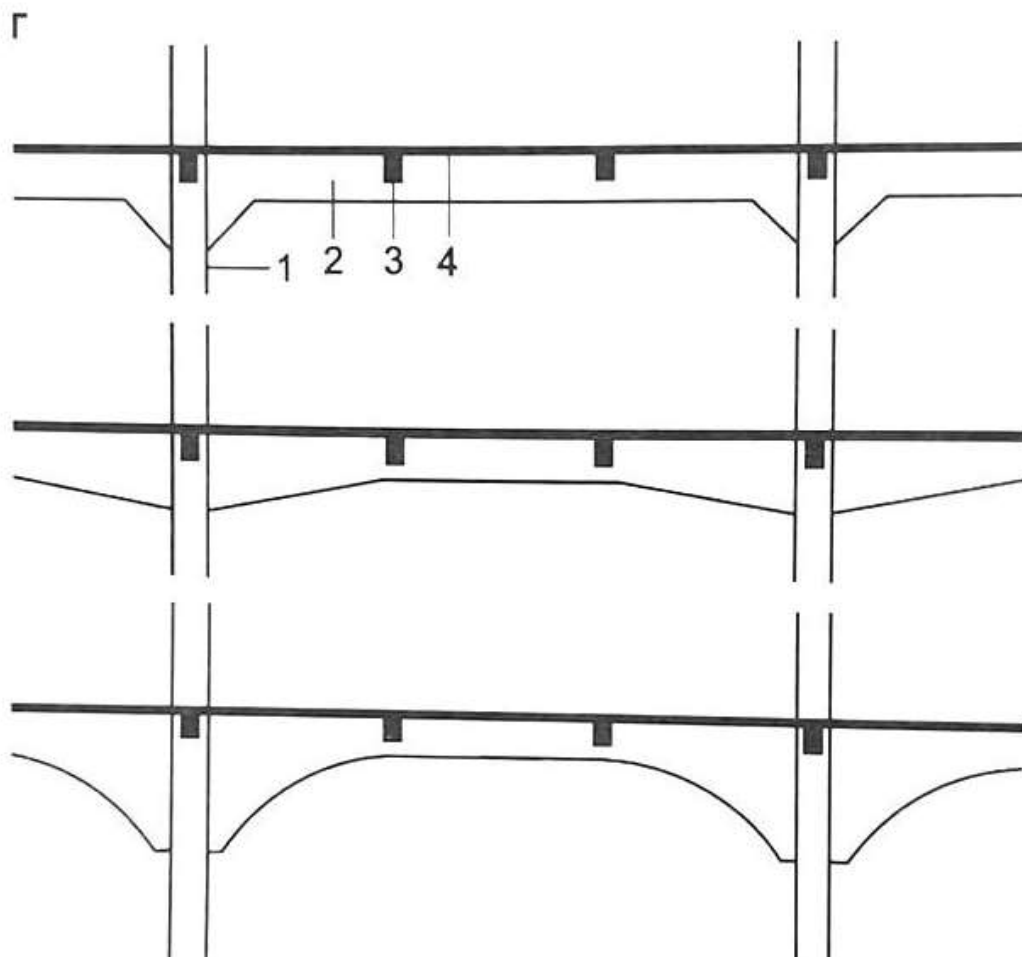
Монолитные железобетонные каркасы с главными и второстепенными балками:
